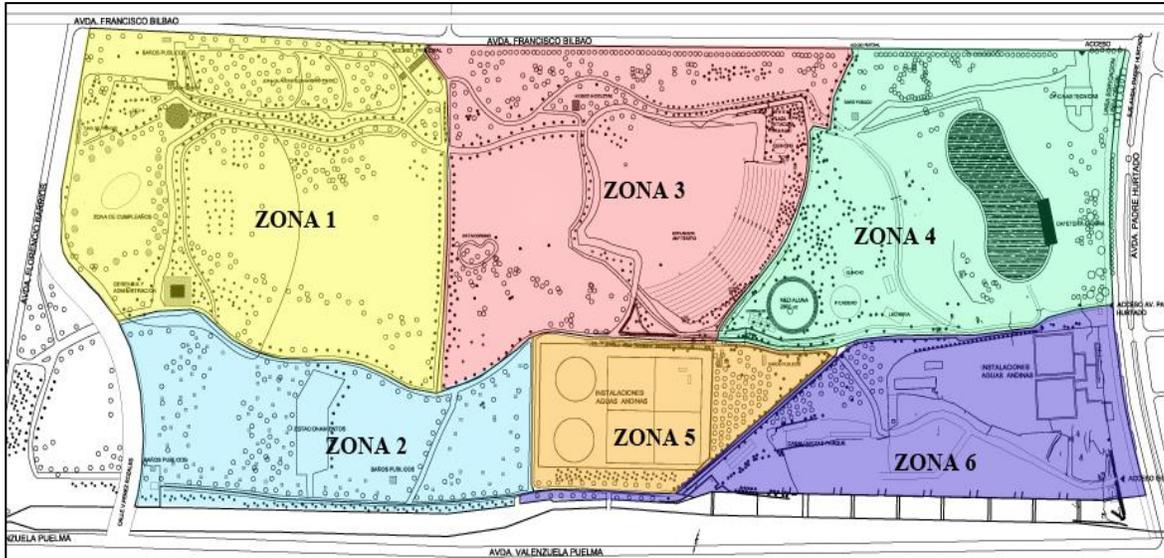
Planta general del Parque Padre Hurtado con la zonificación establecida para el trabajo en terreno.
